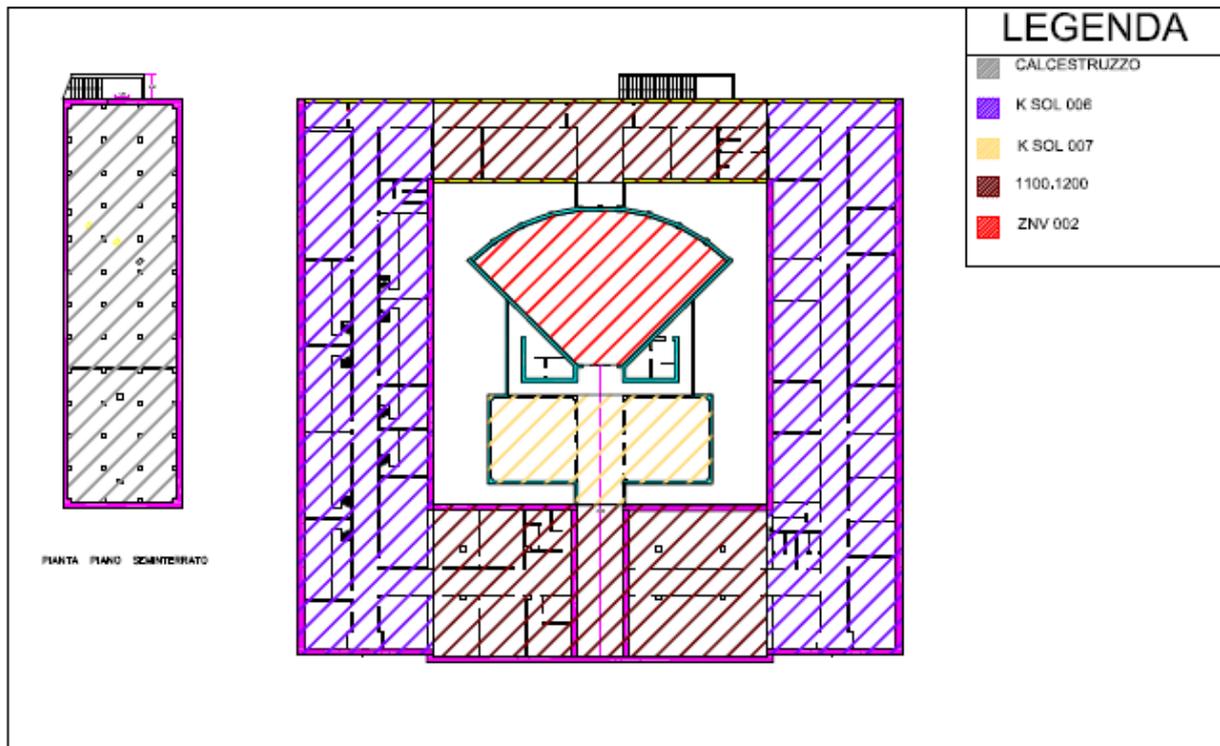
Planimetria piano terra e piano seminterrato Centro Ricerche Sotacarbo
